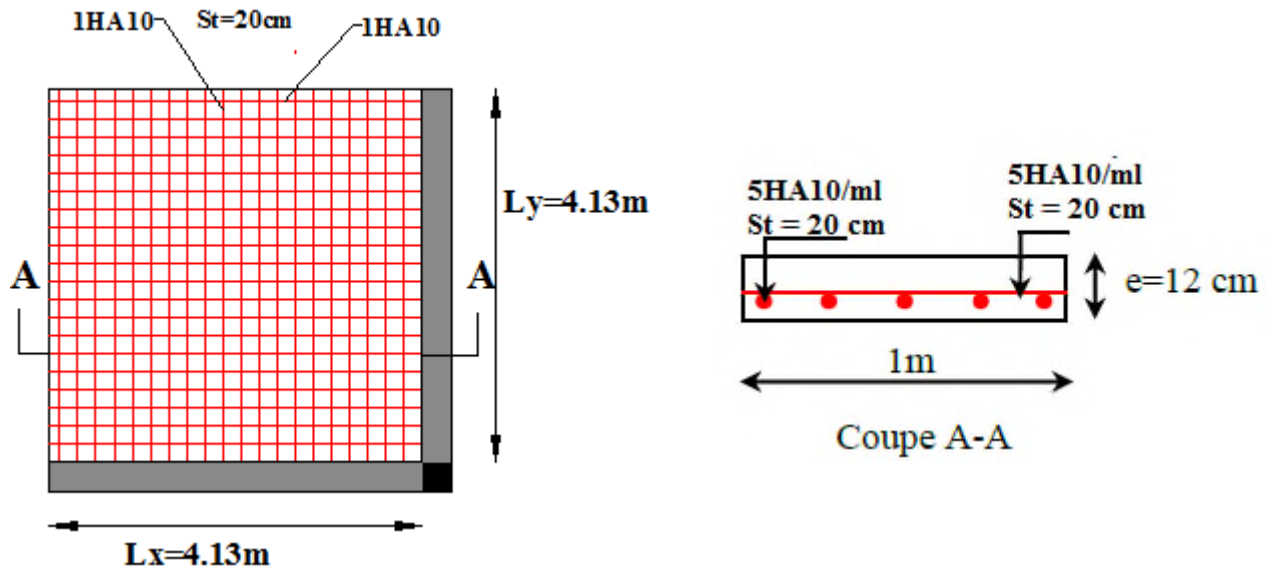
Schémas de ferrailage pour la dalle sur 2 appuis.
